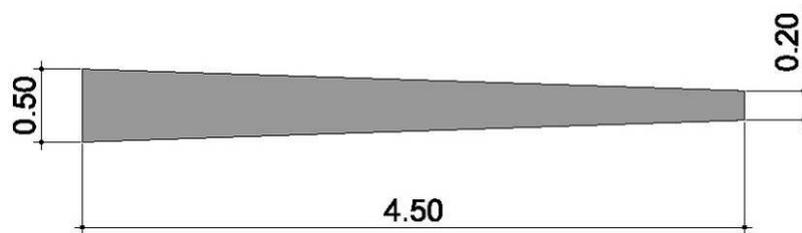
Planta do Pilar Principal. Desenho do autor – adaptado de planta original (IPHAN).
